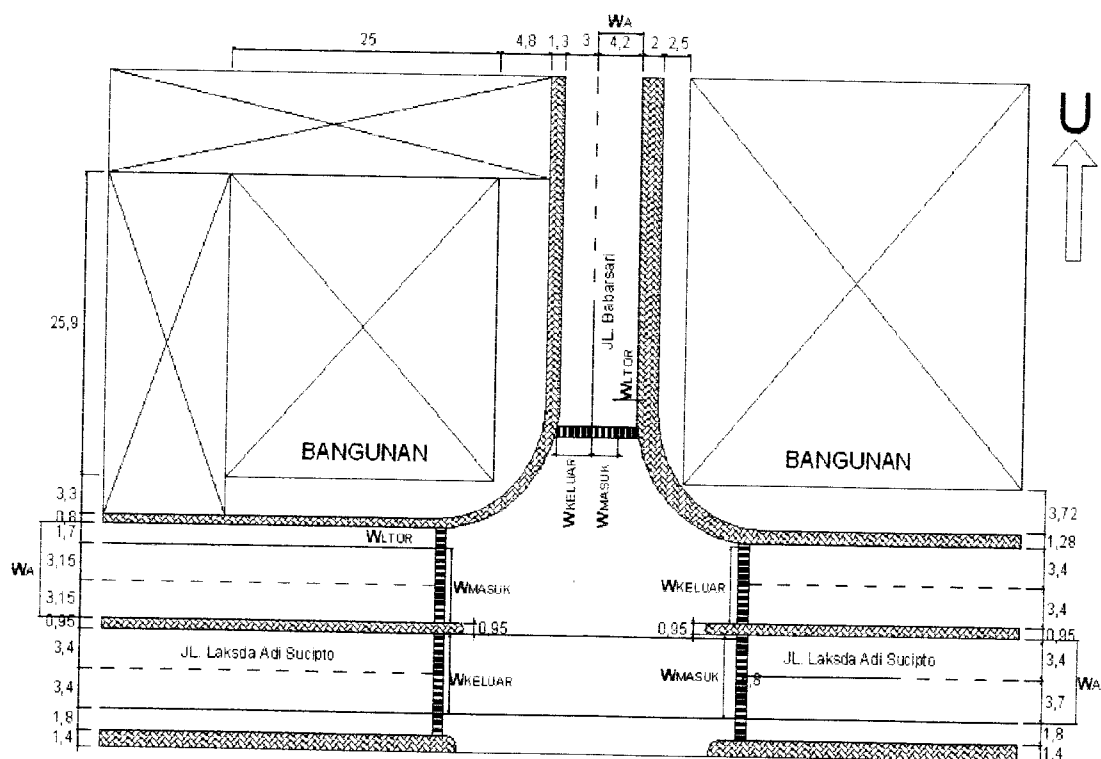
Kondisi geometrik pada simpang Janti
